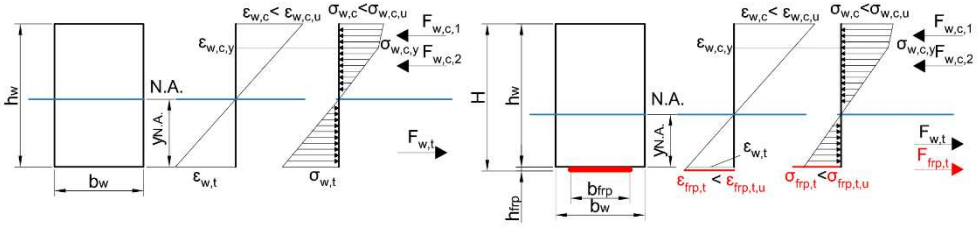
Nomenclatura y diagramas de la relación entre la tensión y la deformación para el modelo en rango elástico de Bazan-Buchanan [9,10]. Izquierda: Sección de una viga no reforzada. Derecha: Sección de una viga reforzada con refuerzo longitudinal.
